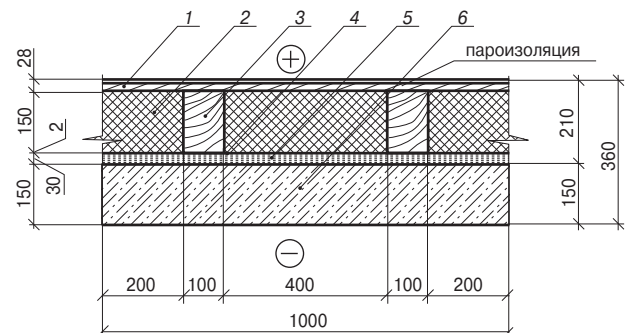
Схема перекрытия 1-го этажа над неотапливаемым подвалом: 1 – доски для покрытия пола; 2 – плитный утеплитель; 3 – деревянные лаги; 4 – керамическое теплоизоляционное покрытие; 5 – стяжка из цементно-песчаного раствора; 6 – железобетонное монолитное перекрытие
